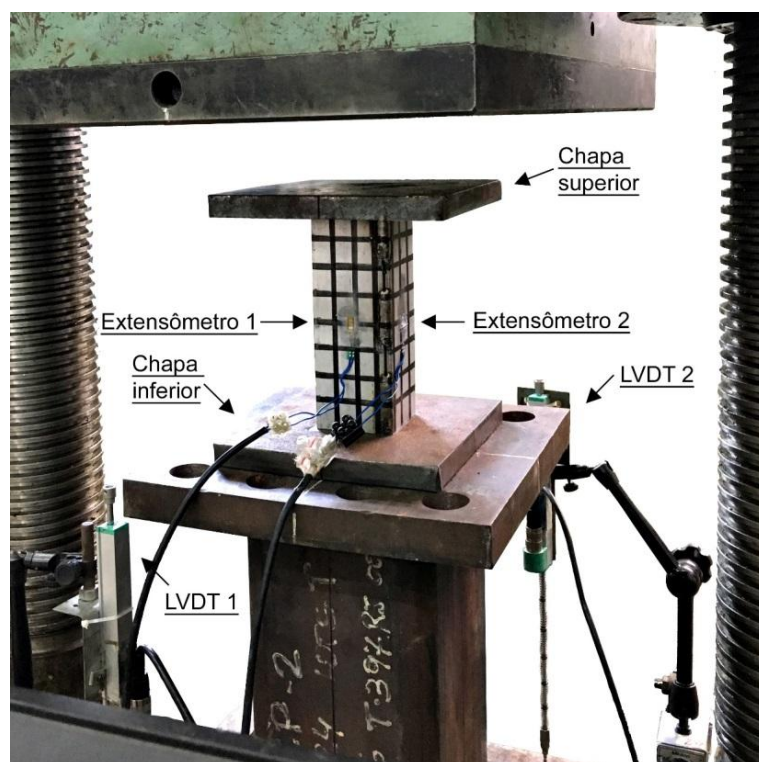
Organização geral do ensaio de caracterização a compressão.
